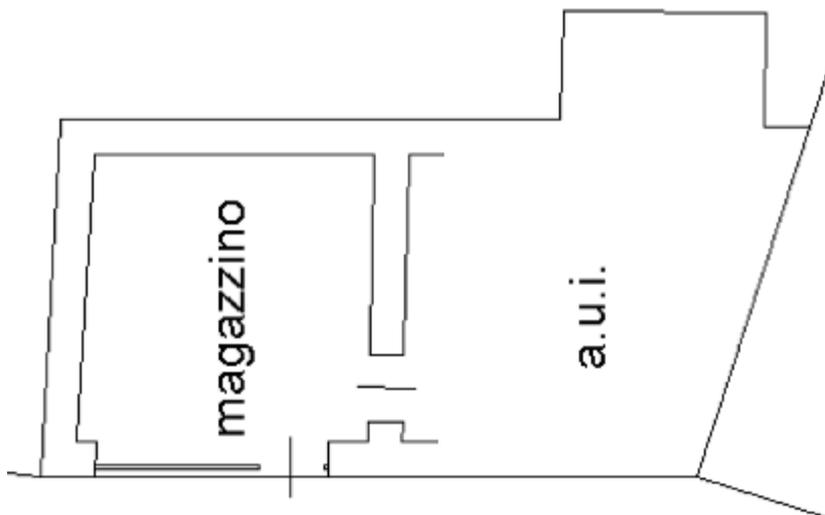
Planimetria catastali dei beni, sub. 3 (p.t.).
